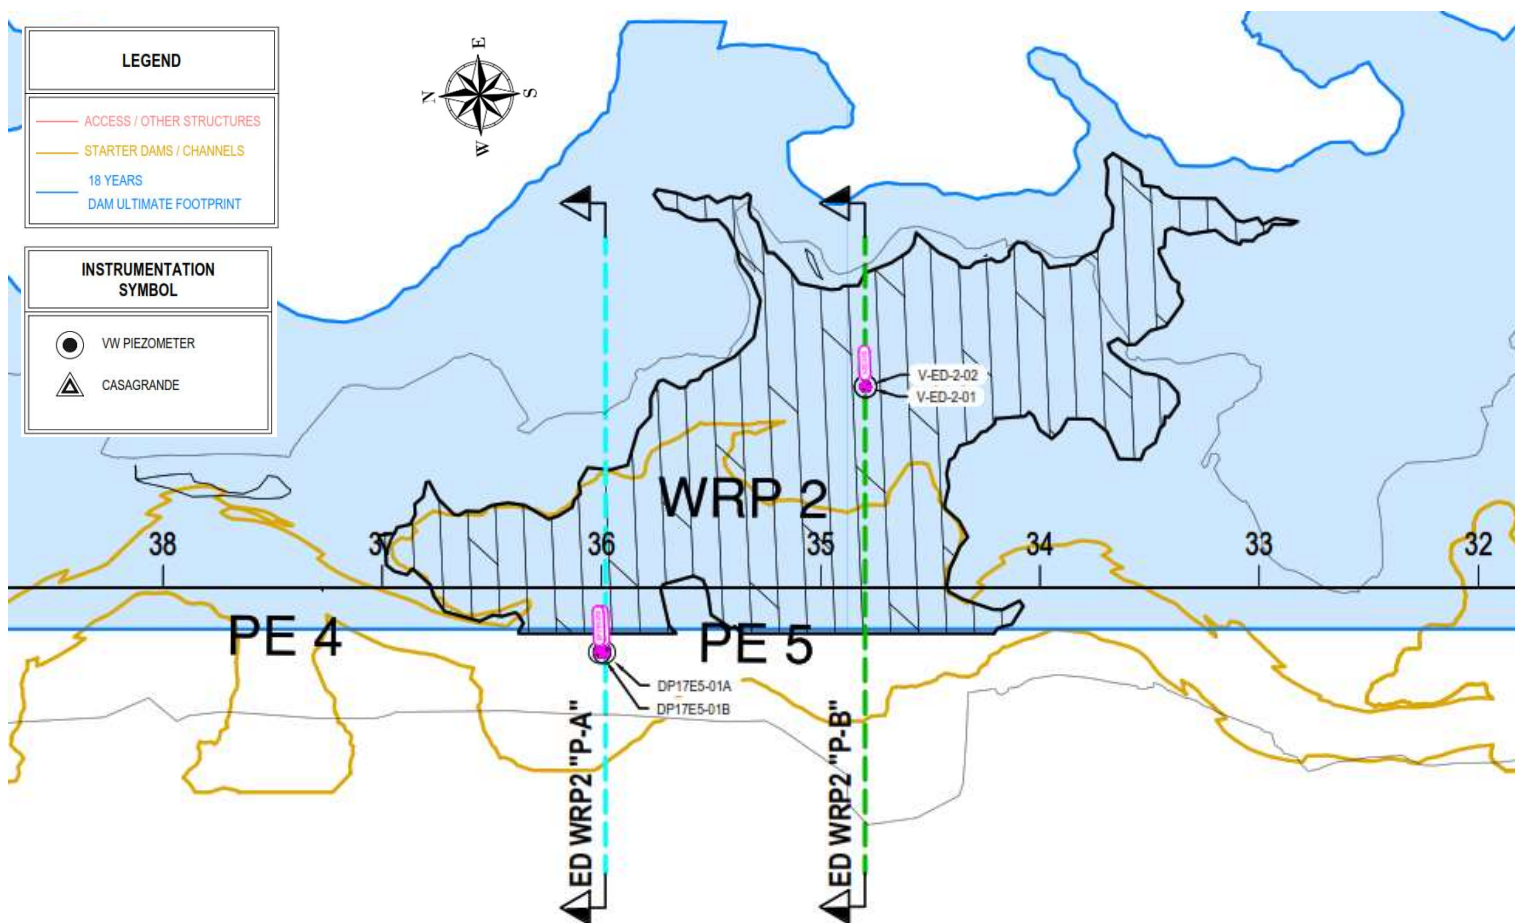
1: Vista en planta de la PE WRP2 - Grupos de instrumentos Piezometro y Casagrande
